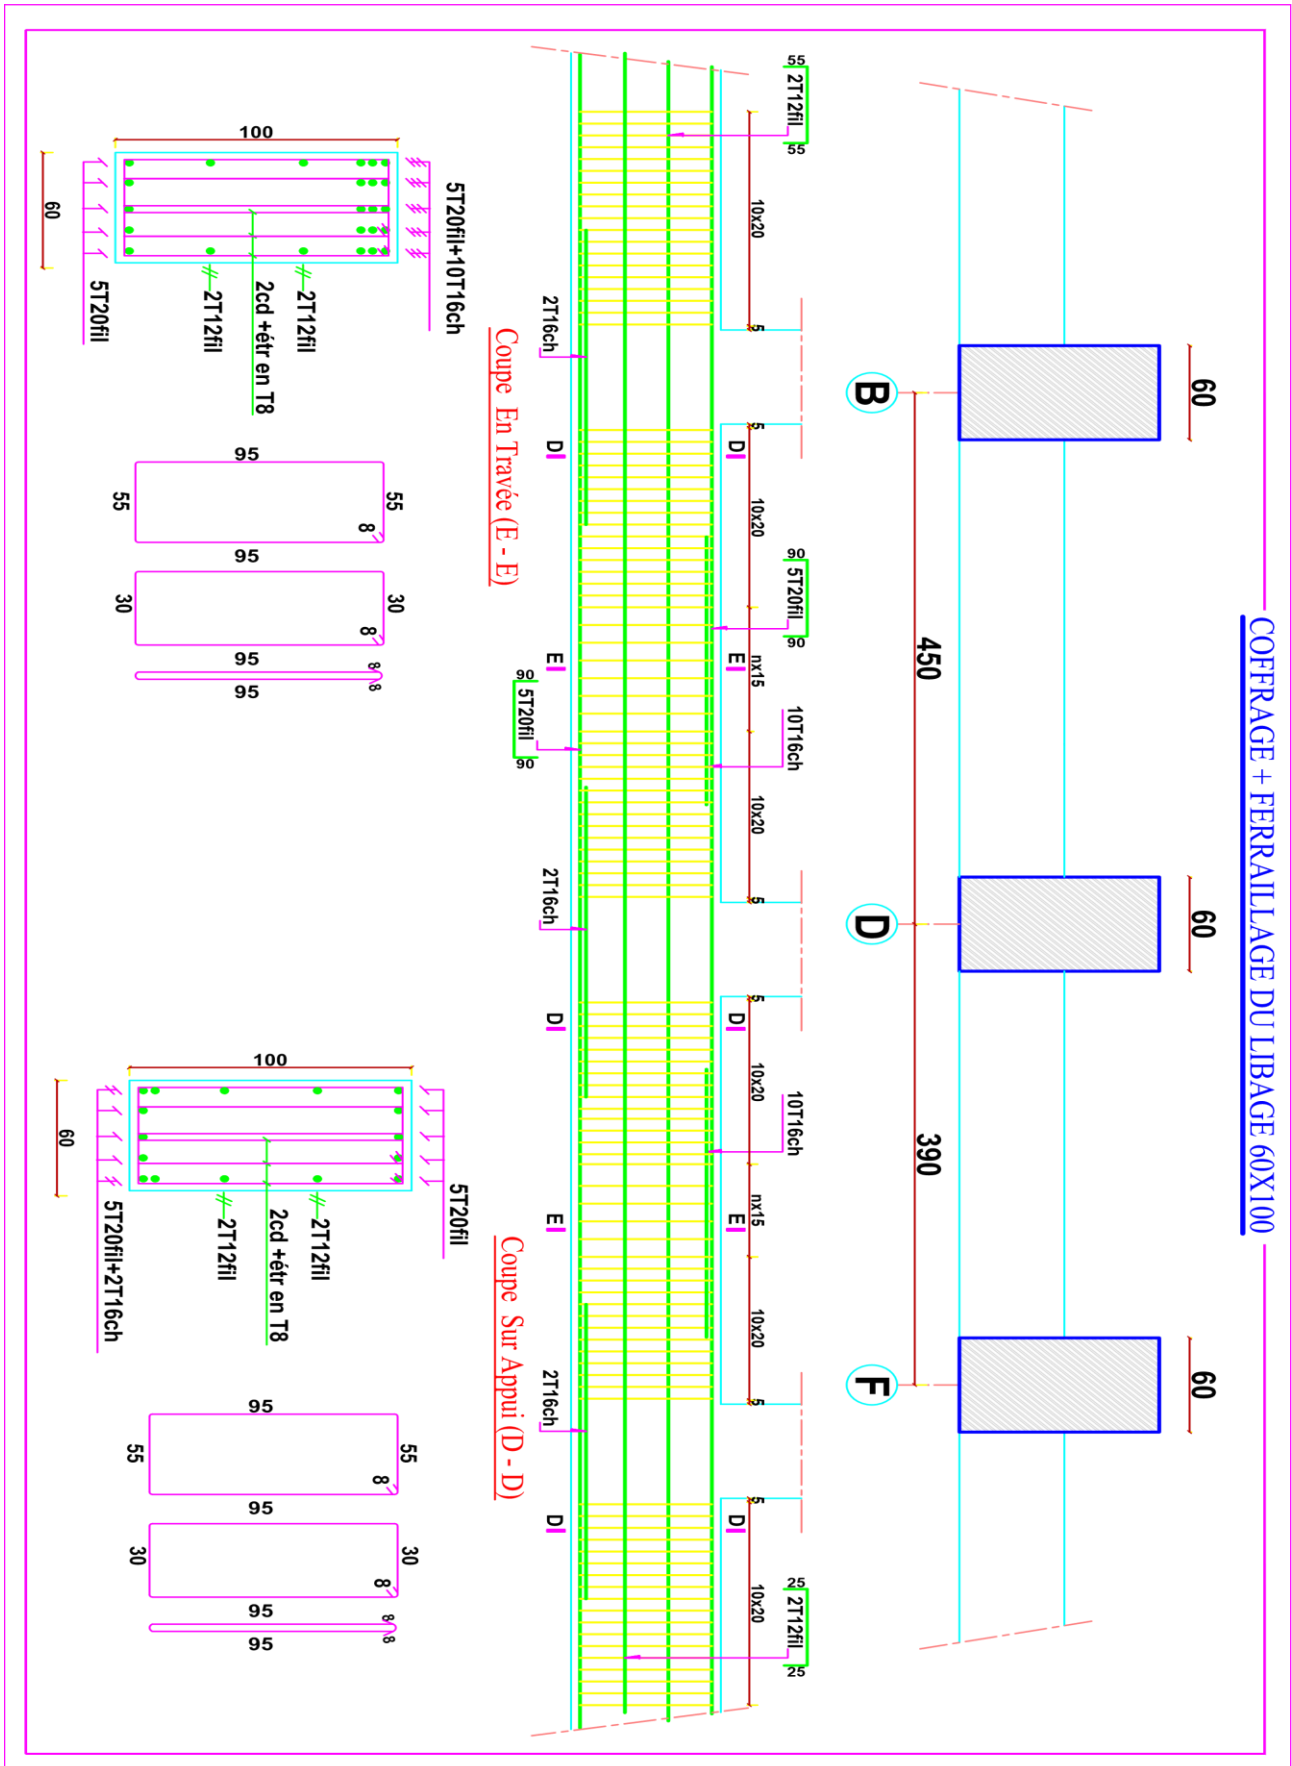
Schéma de coffrage et ferrailage des nervures
